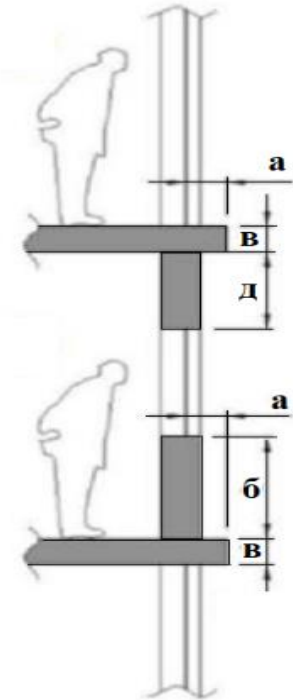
Приклад будівельної конструкції висотної громадської будівлі, яка зменшує площу світлового прорізу у фасаді висотної громадської будівлі для обмеження можливої теплопередачі від пожежі, де
